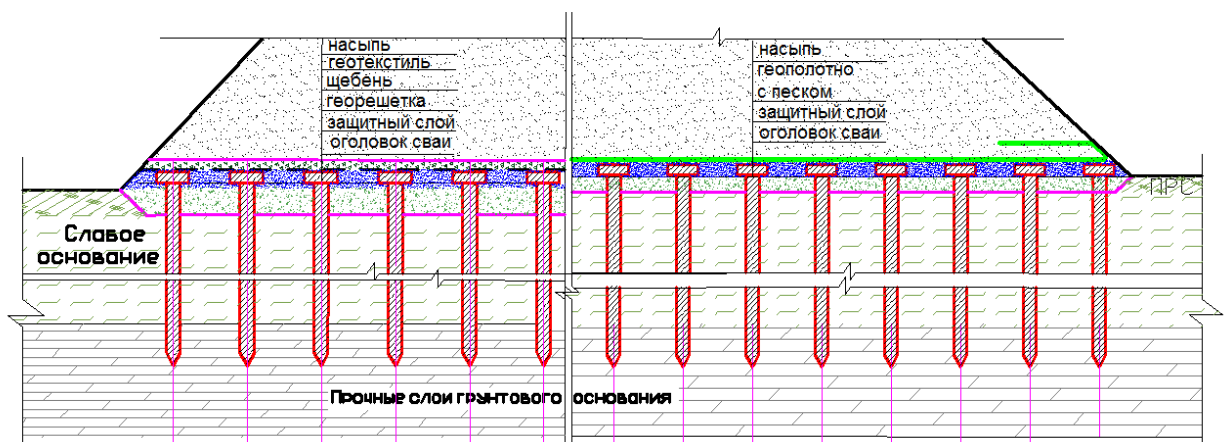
Общий вид гибких ростверков на свайном фундаменте
